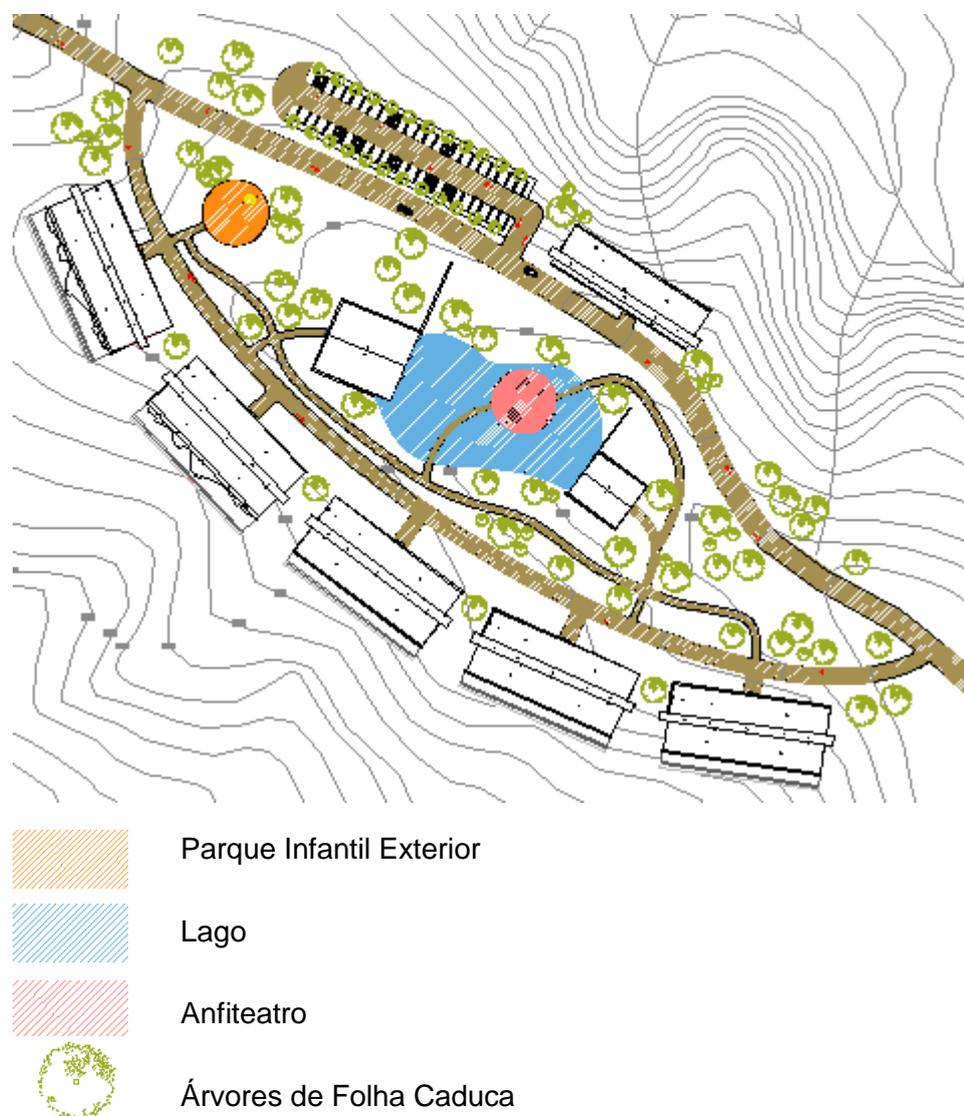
Planta de Implantação Evidenciando os Espaços Exteriores.
